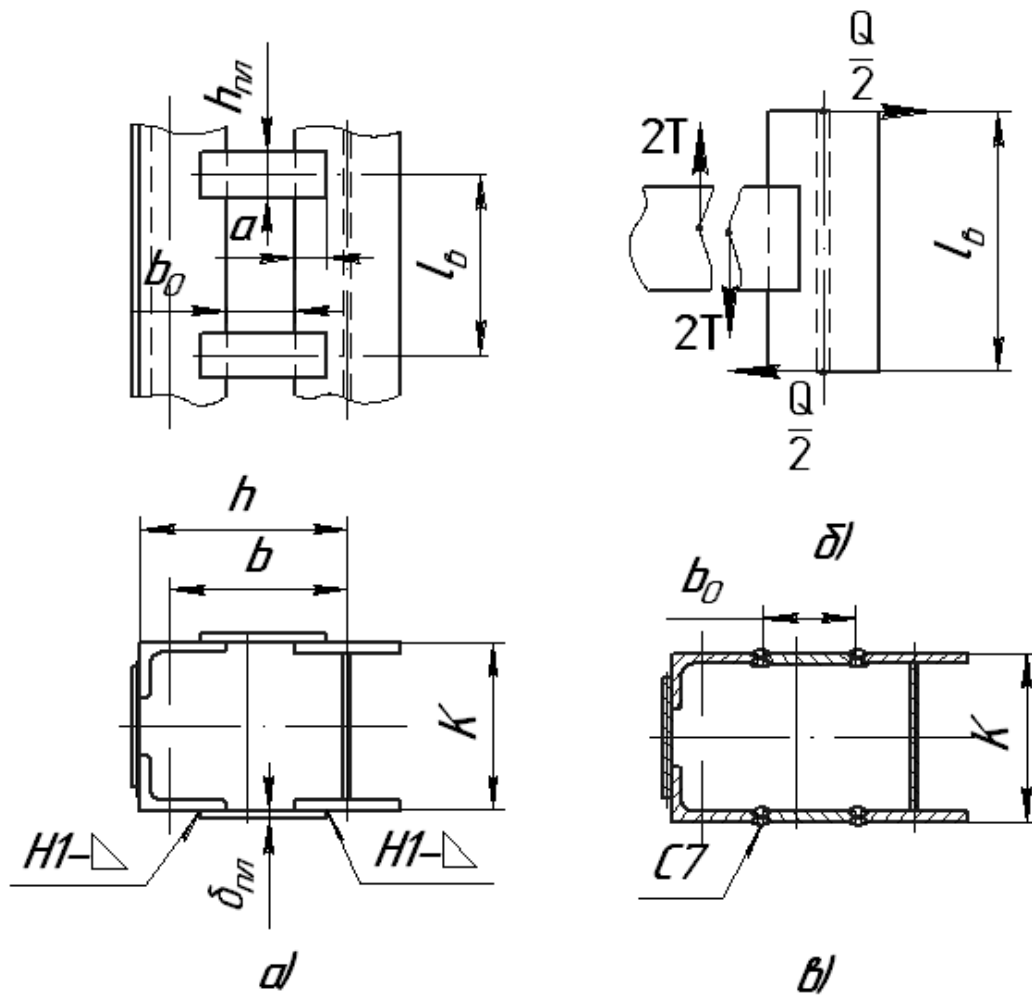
Способи кріплення з'єднувальних планок
